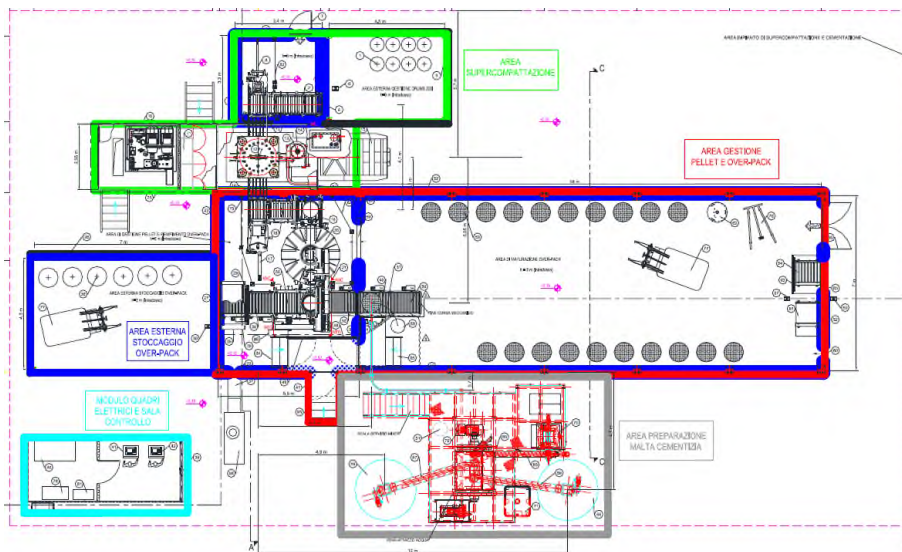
Planimetria dell'impianto di super-compattazione e cementazione
